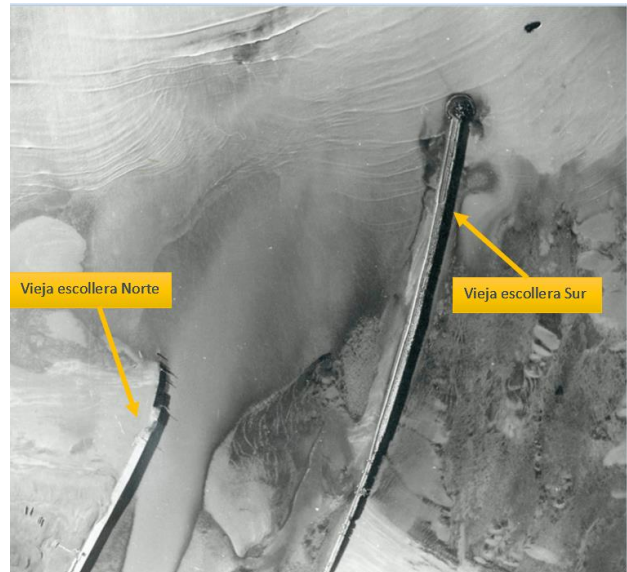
Viejas escolleras Norte y Sur. (Fuente: Dirección de Infraestructura Portuaria)
